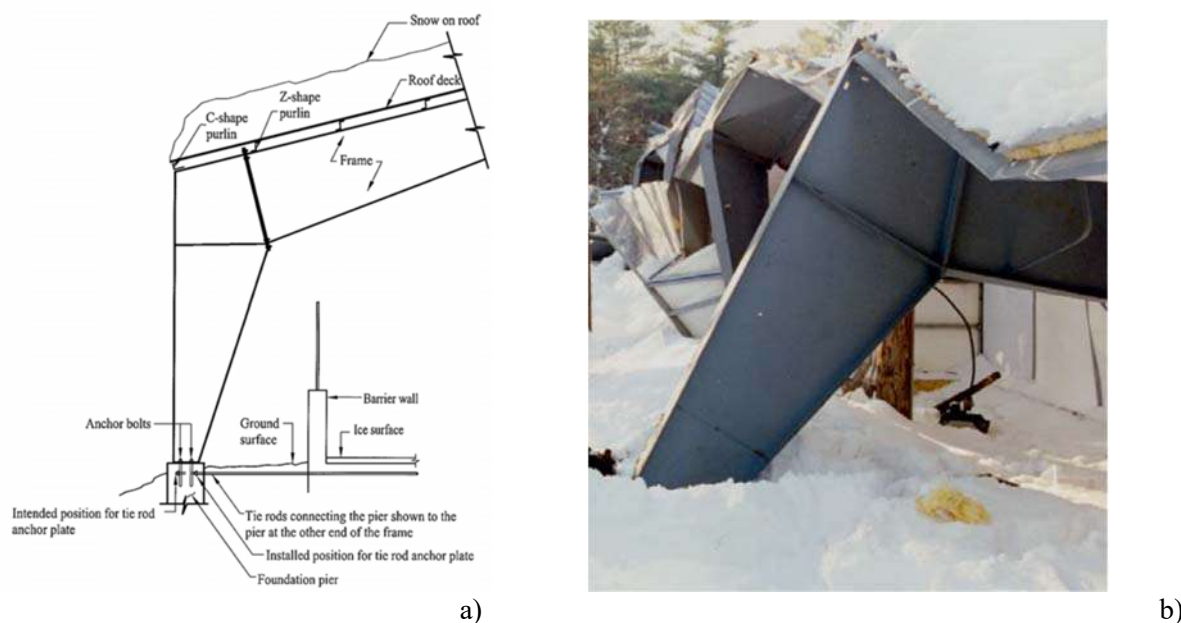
Jackson Landing Skating Rink: a) dettagli della struttura; b) collasso dei telai trasversali (Ellingwood et al., 2007)
